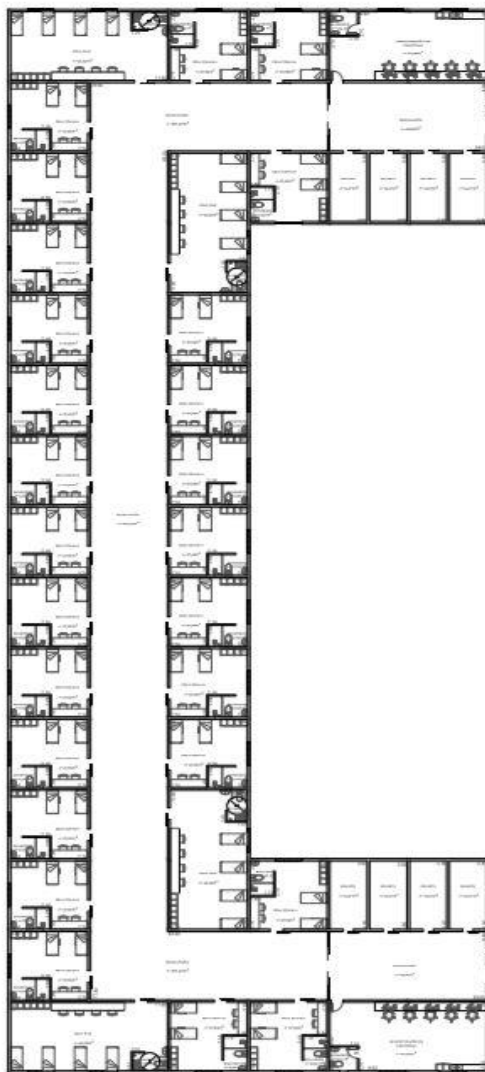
Planta Humanizada – Fonte: Acervo Próprio
